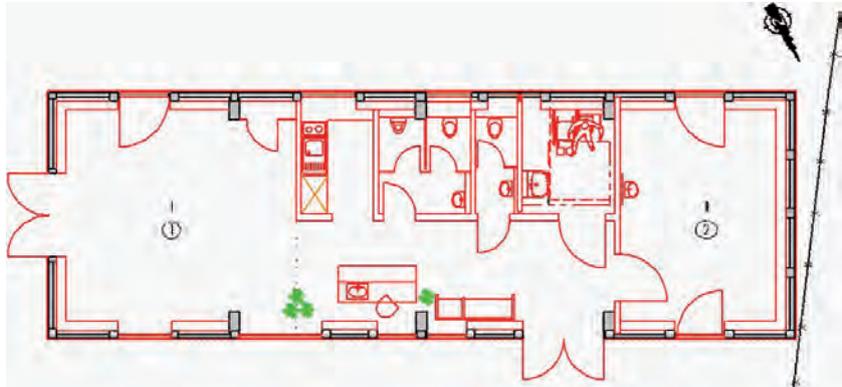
Grundriss „Alte Mühle m.H.“
